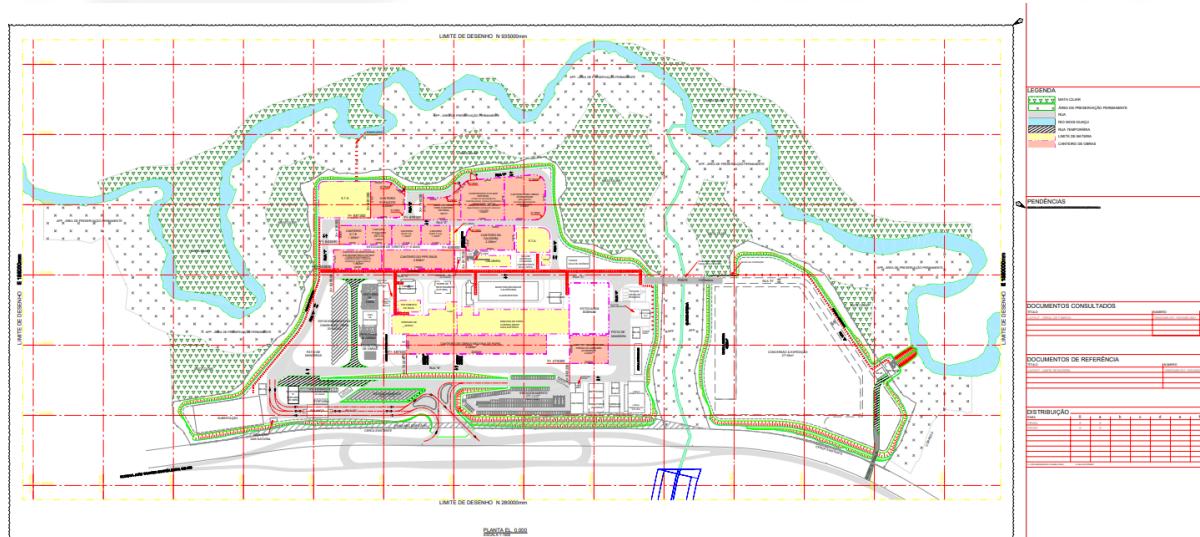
Em laranja, áreas utilizadas para canteiro de obras.
